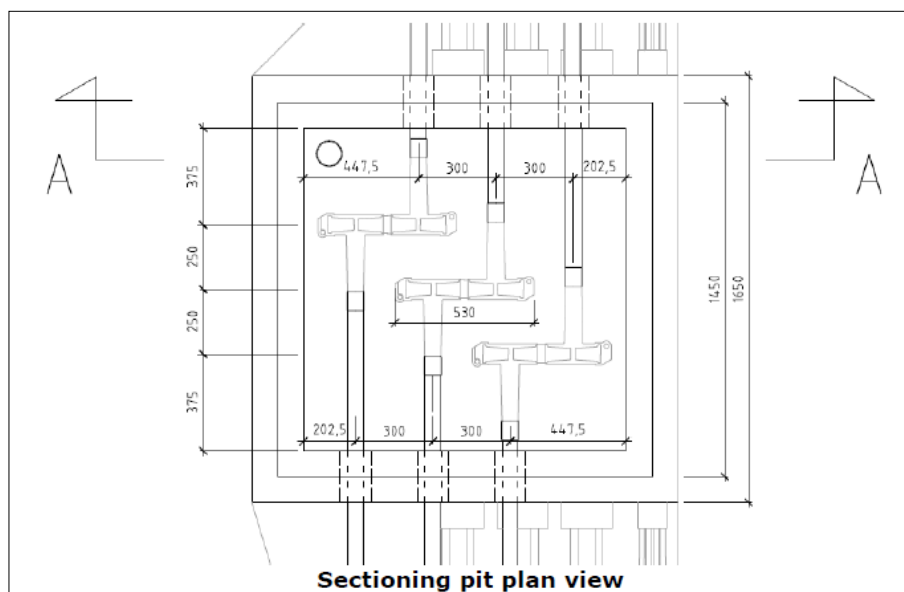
Vista in pianta dei giunti sconnettabili all'interno dei pozzettoni di sezionamento
